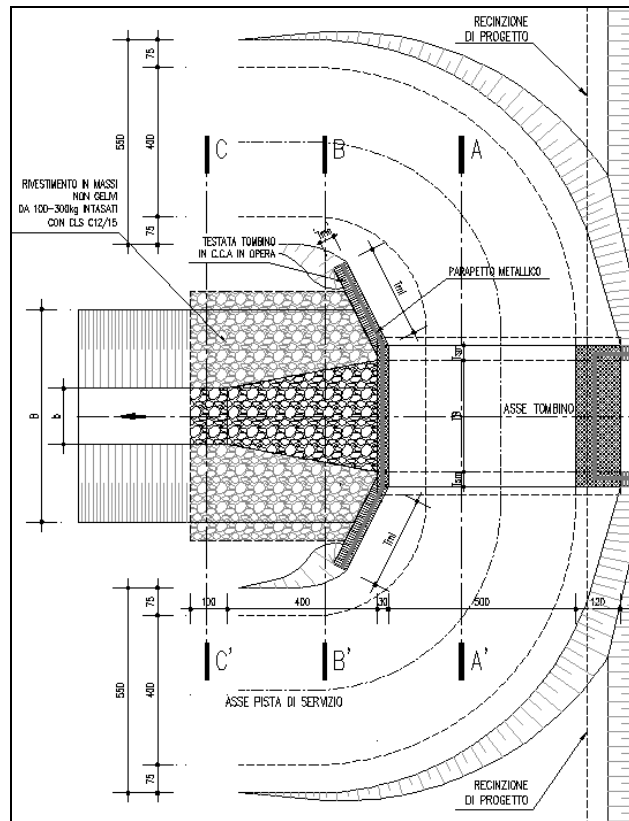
PLANIMETRIA IMBOCCO/SBOCCO CONSORZIO DI BONIFICA BURANA
